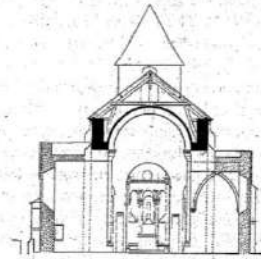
COUPE TRANSVERSALE DE LA NEF
